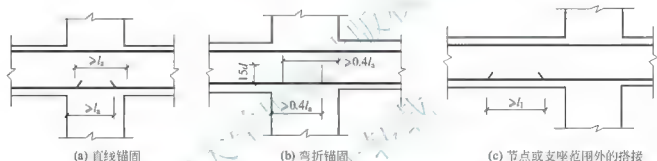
梁下部纵向钢筋在中间节点或中间支座范围的锚固
